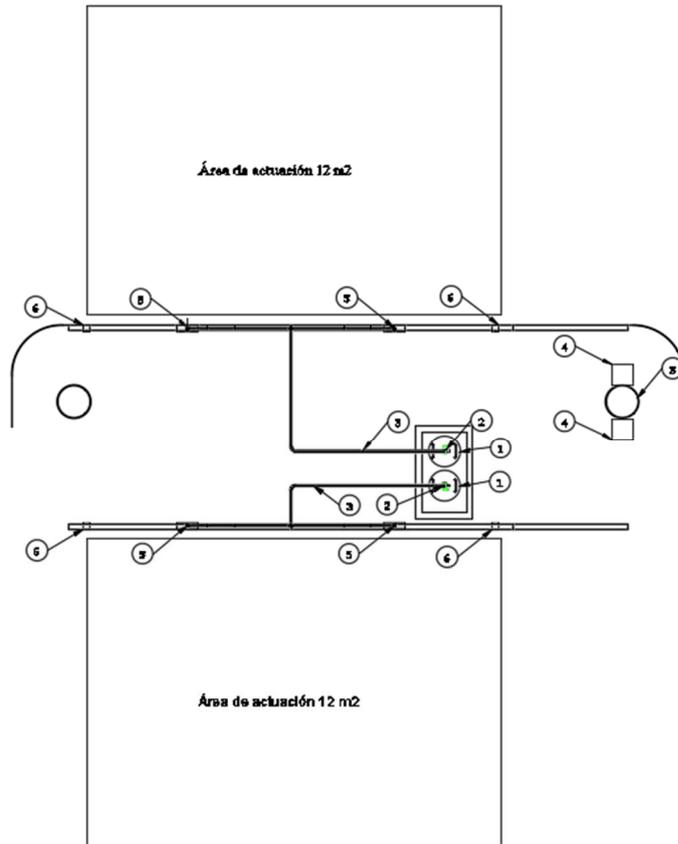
Disposición de los elementos del sistema KIT PETCI, visto en planta
